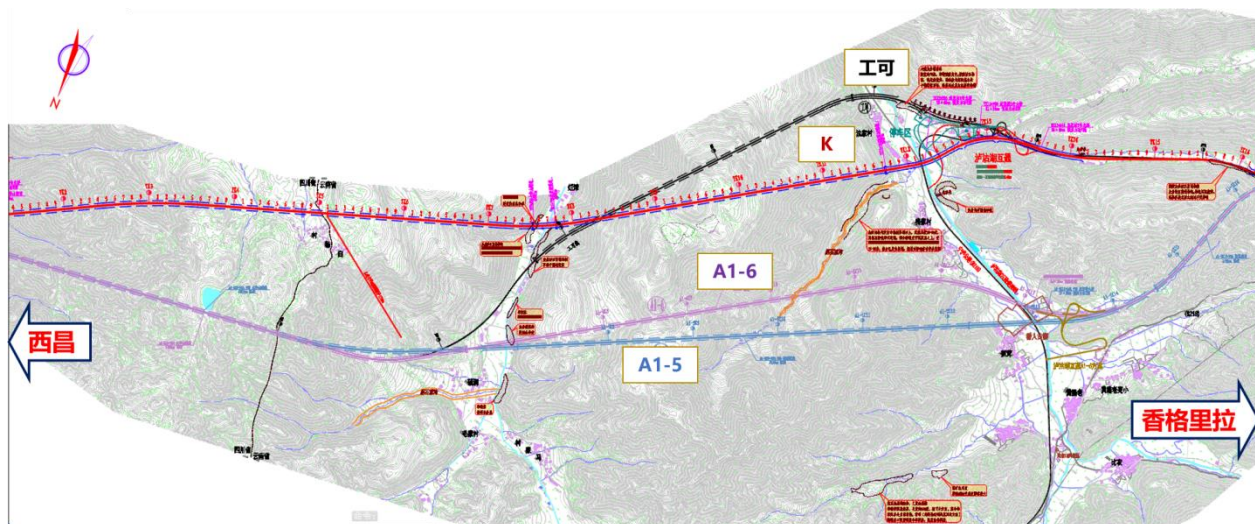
A1-5、A1-6 方案比较平面图
